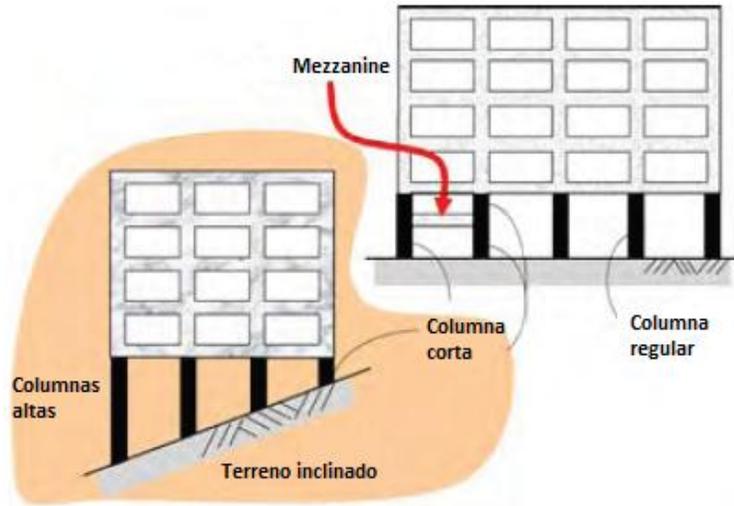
Ejemplos de construcción común de edificios con columnas cortas (fuente: Murty 2005).
